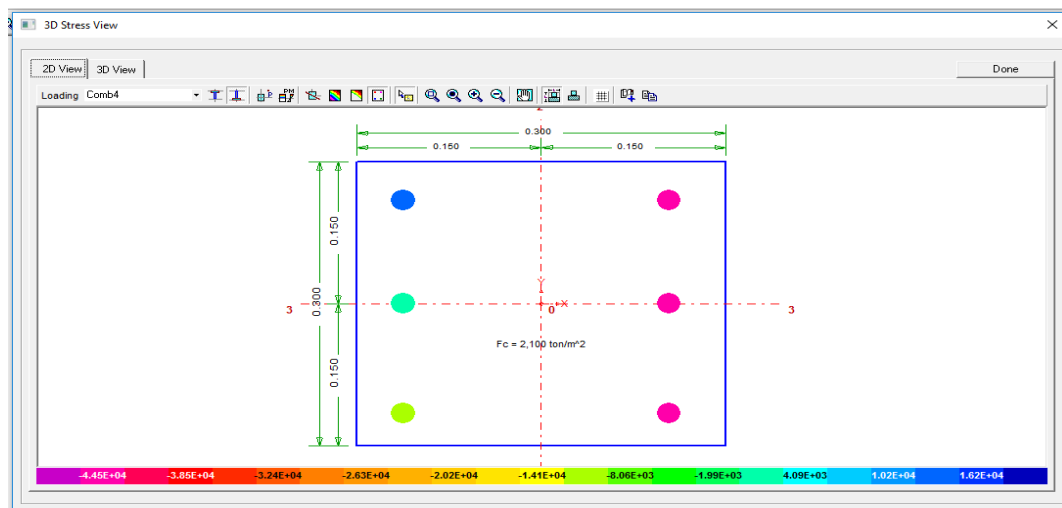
Esfuerzos de las barras de acero de la columna de sección Rectangular en el programa CSICOL 9
